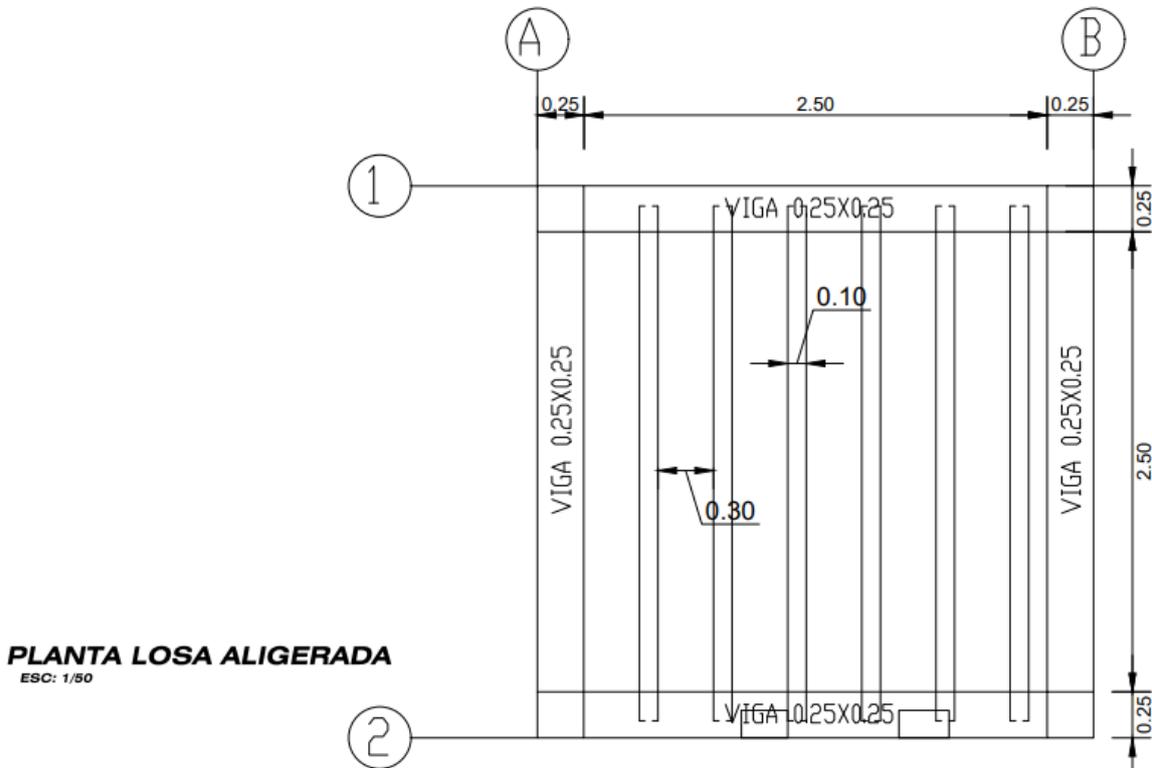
Planta Losa Aligerada de Caseta de Bombeo
